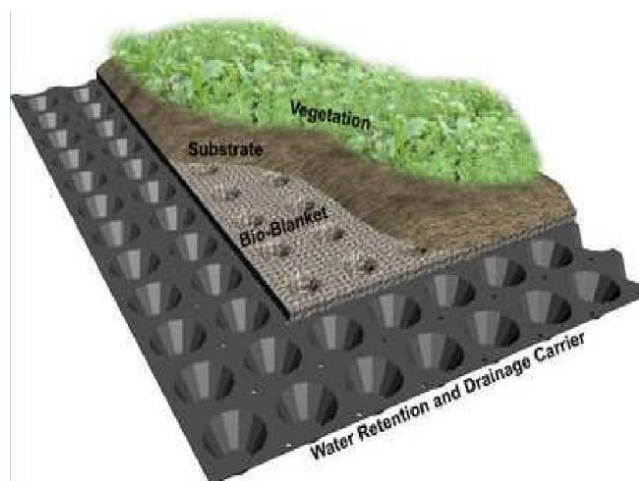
Esquema tridimensional de detalhamento de telhado verde.
